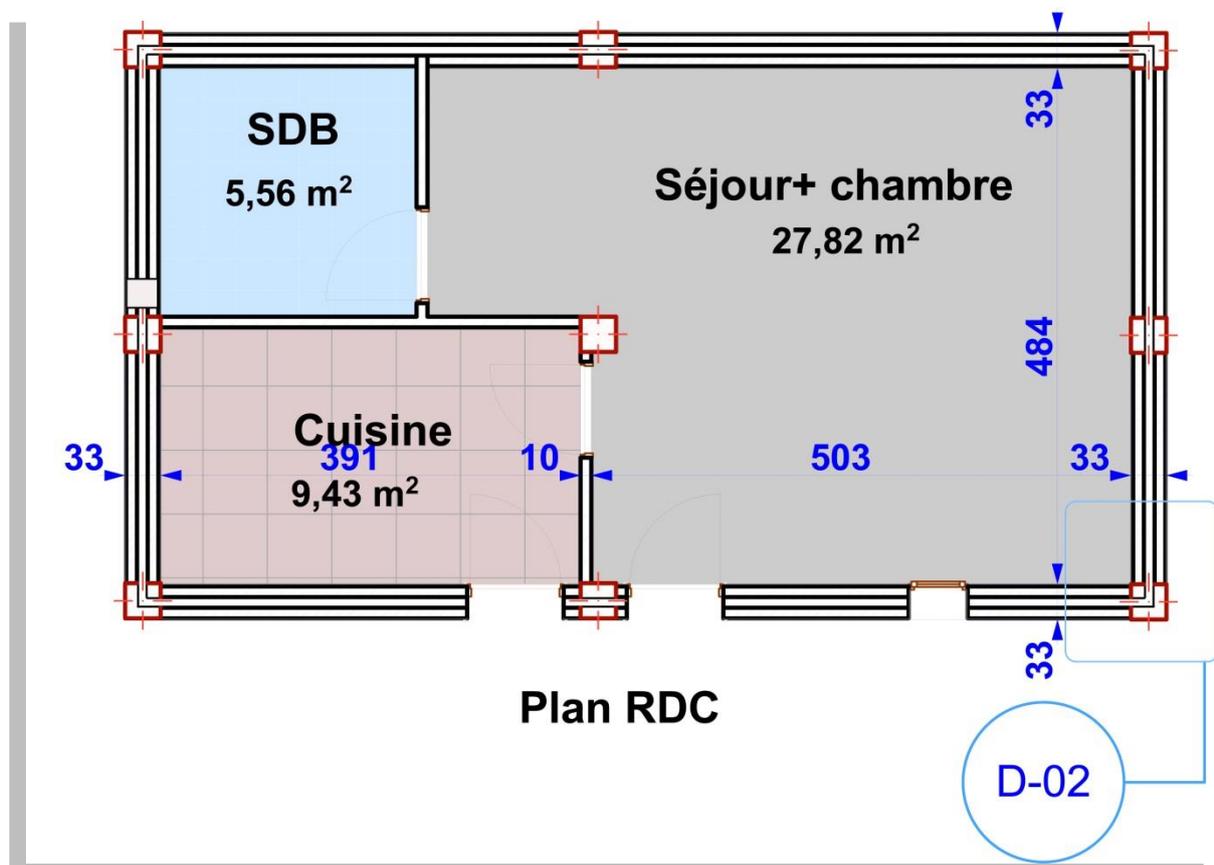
Plan RDC.(Source : modélisation sur Archicad
